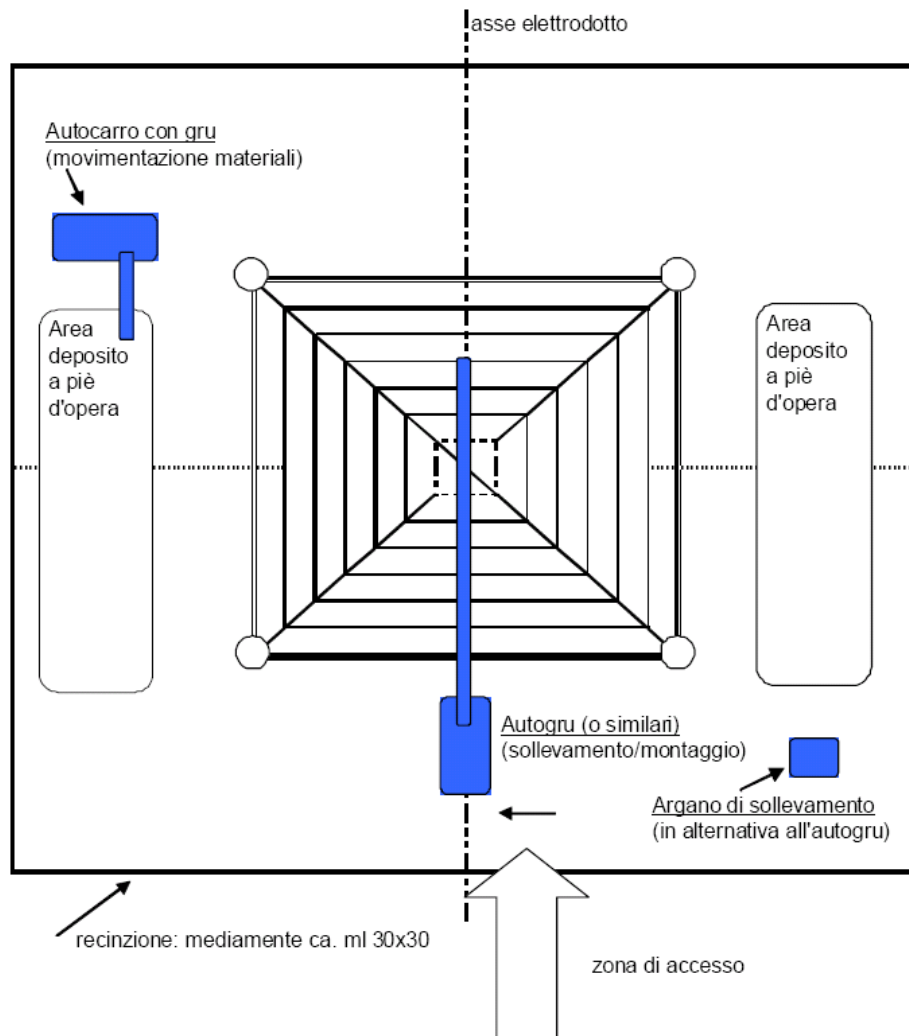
Planimetria dell'Area Sostegno (montaggio sostegno)
